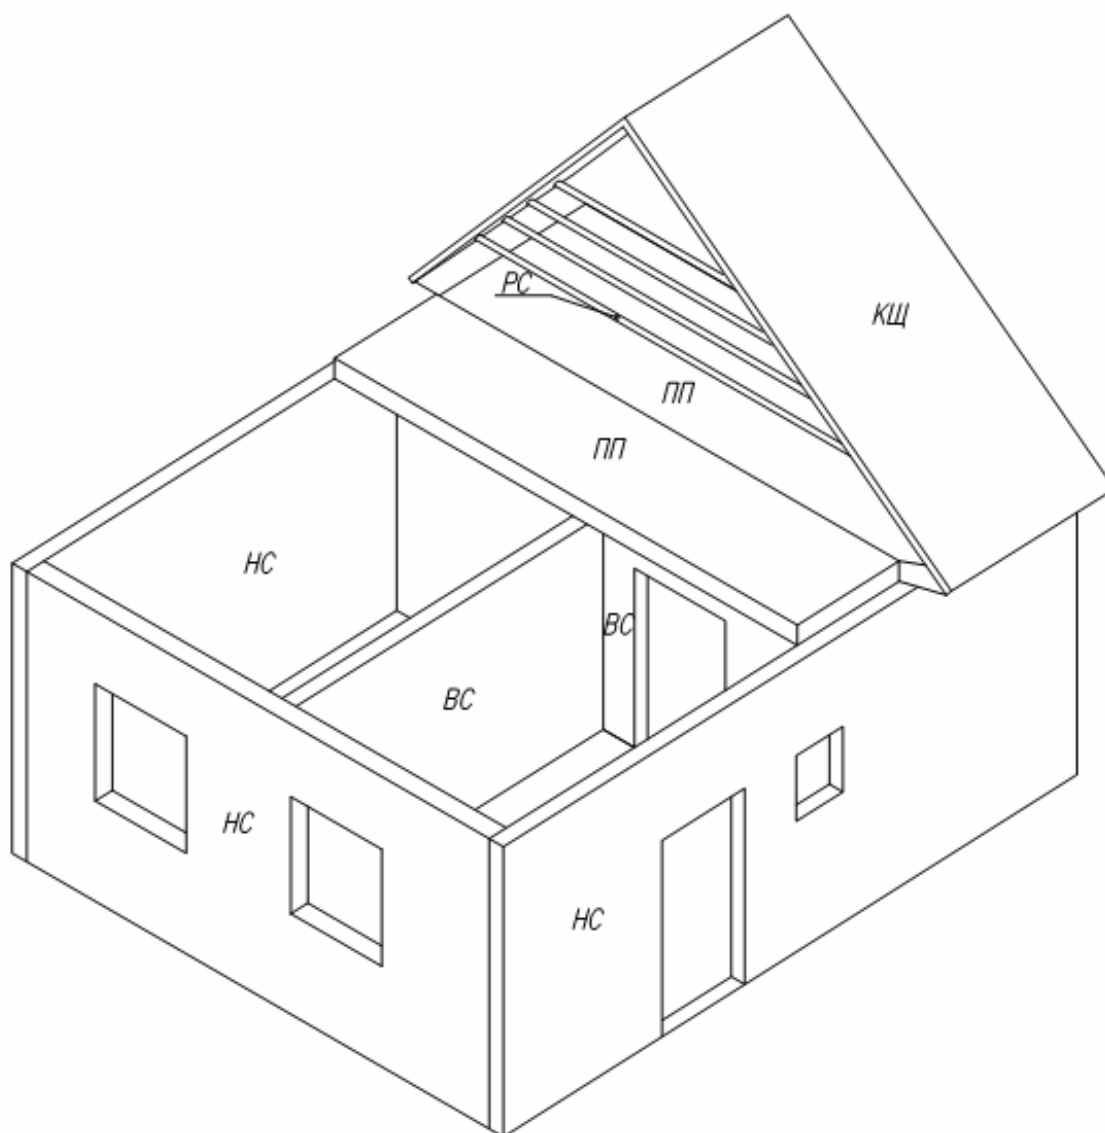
Общая конструктивная схема полносборного крупнопанельного дома: НС – наружная стеновая панель; ВС – внутренняя стеновая панель; ПП – панель перекрытия; РС – ригель-распорка; КЩ – кровельный щит
